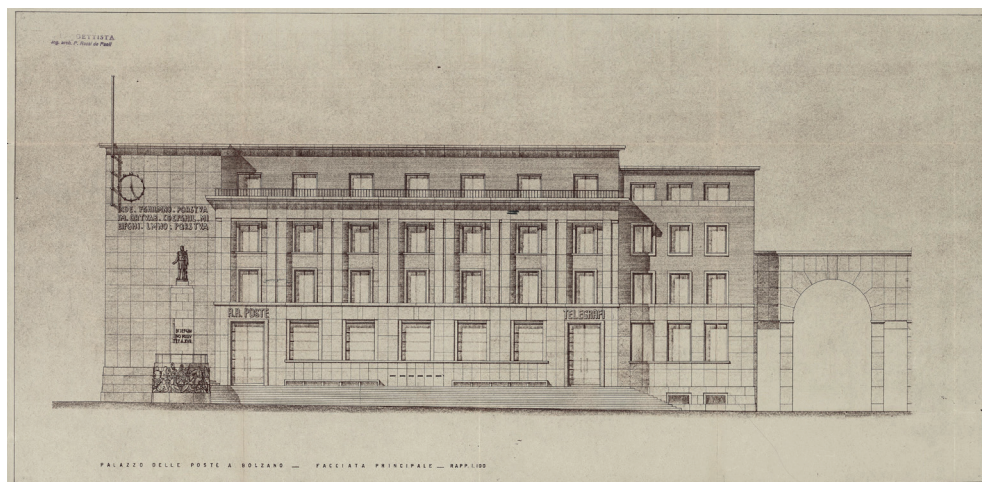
Prospetto del progetto dell'architetto Rossi De Paoli per l'Ufficio delle Poste in piazza Impero, 1936-1939 ca. Archivio Storico della Città di Bolzano
